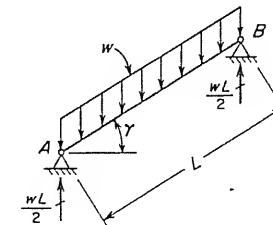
Acciones de extremo para un miembro fijo de armadura
